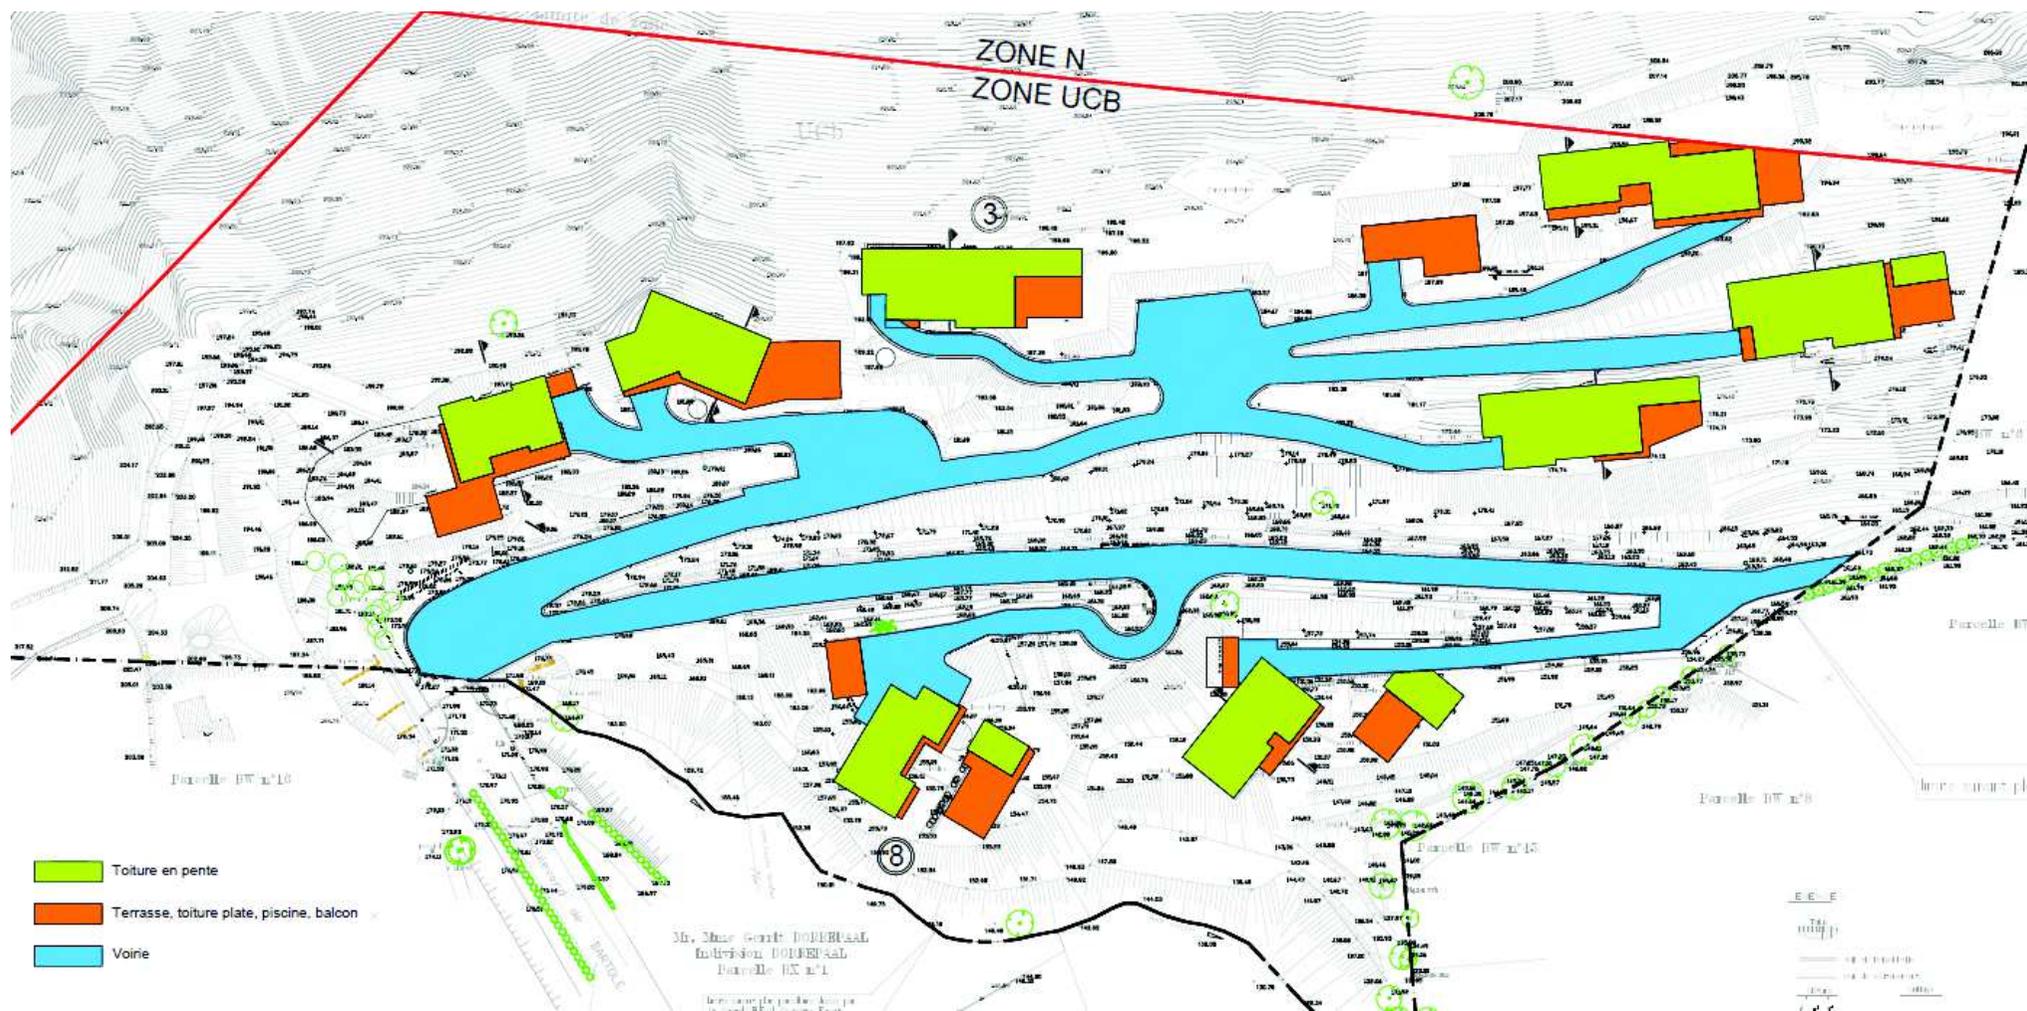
Repérage des surfaces imperméabilisées (source : Gilbert et associés architecte)
